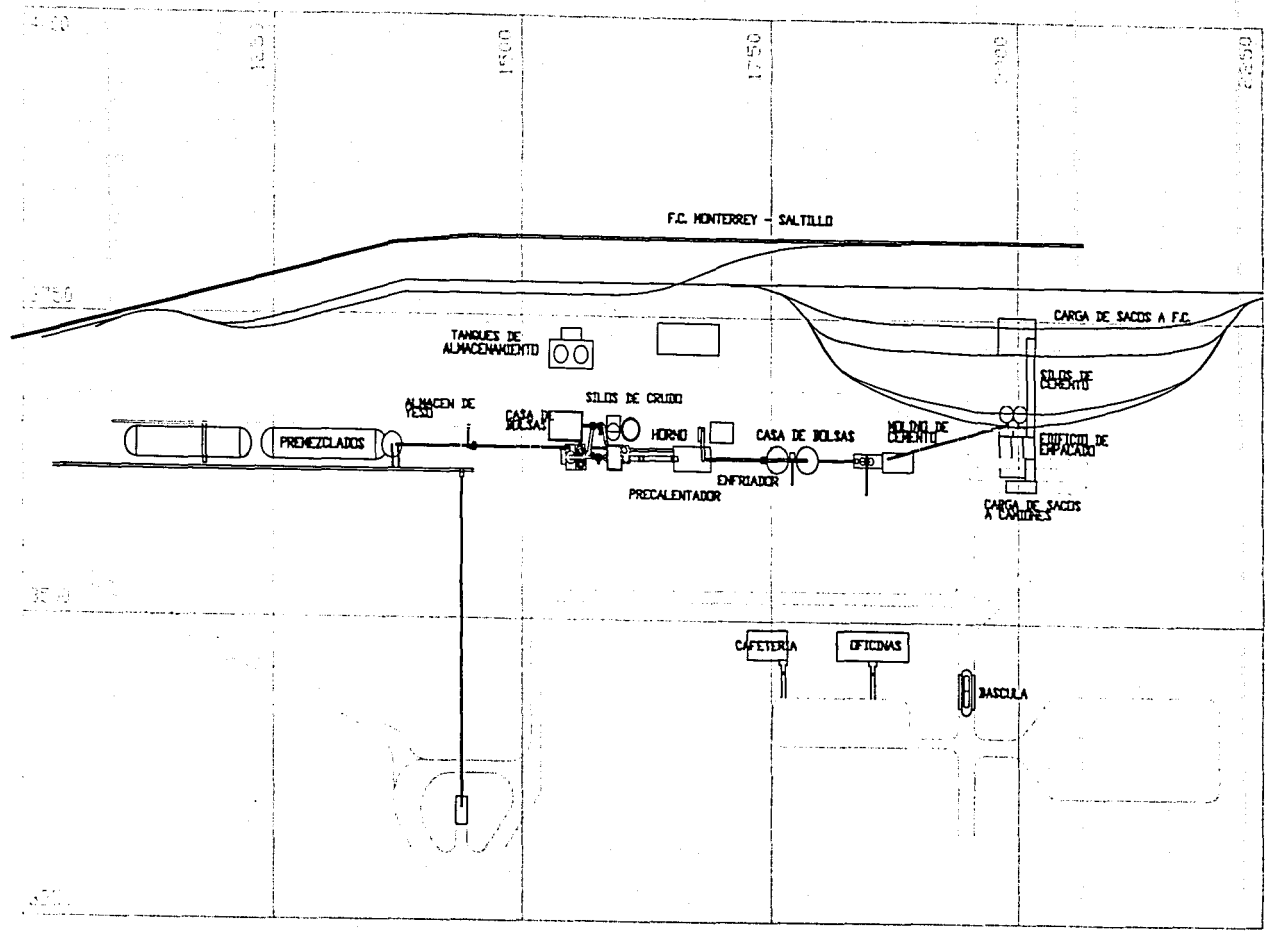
ARREGLO INICIAL DE LA PLANTA
